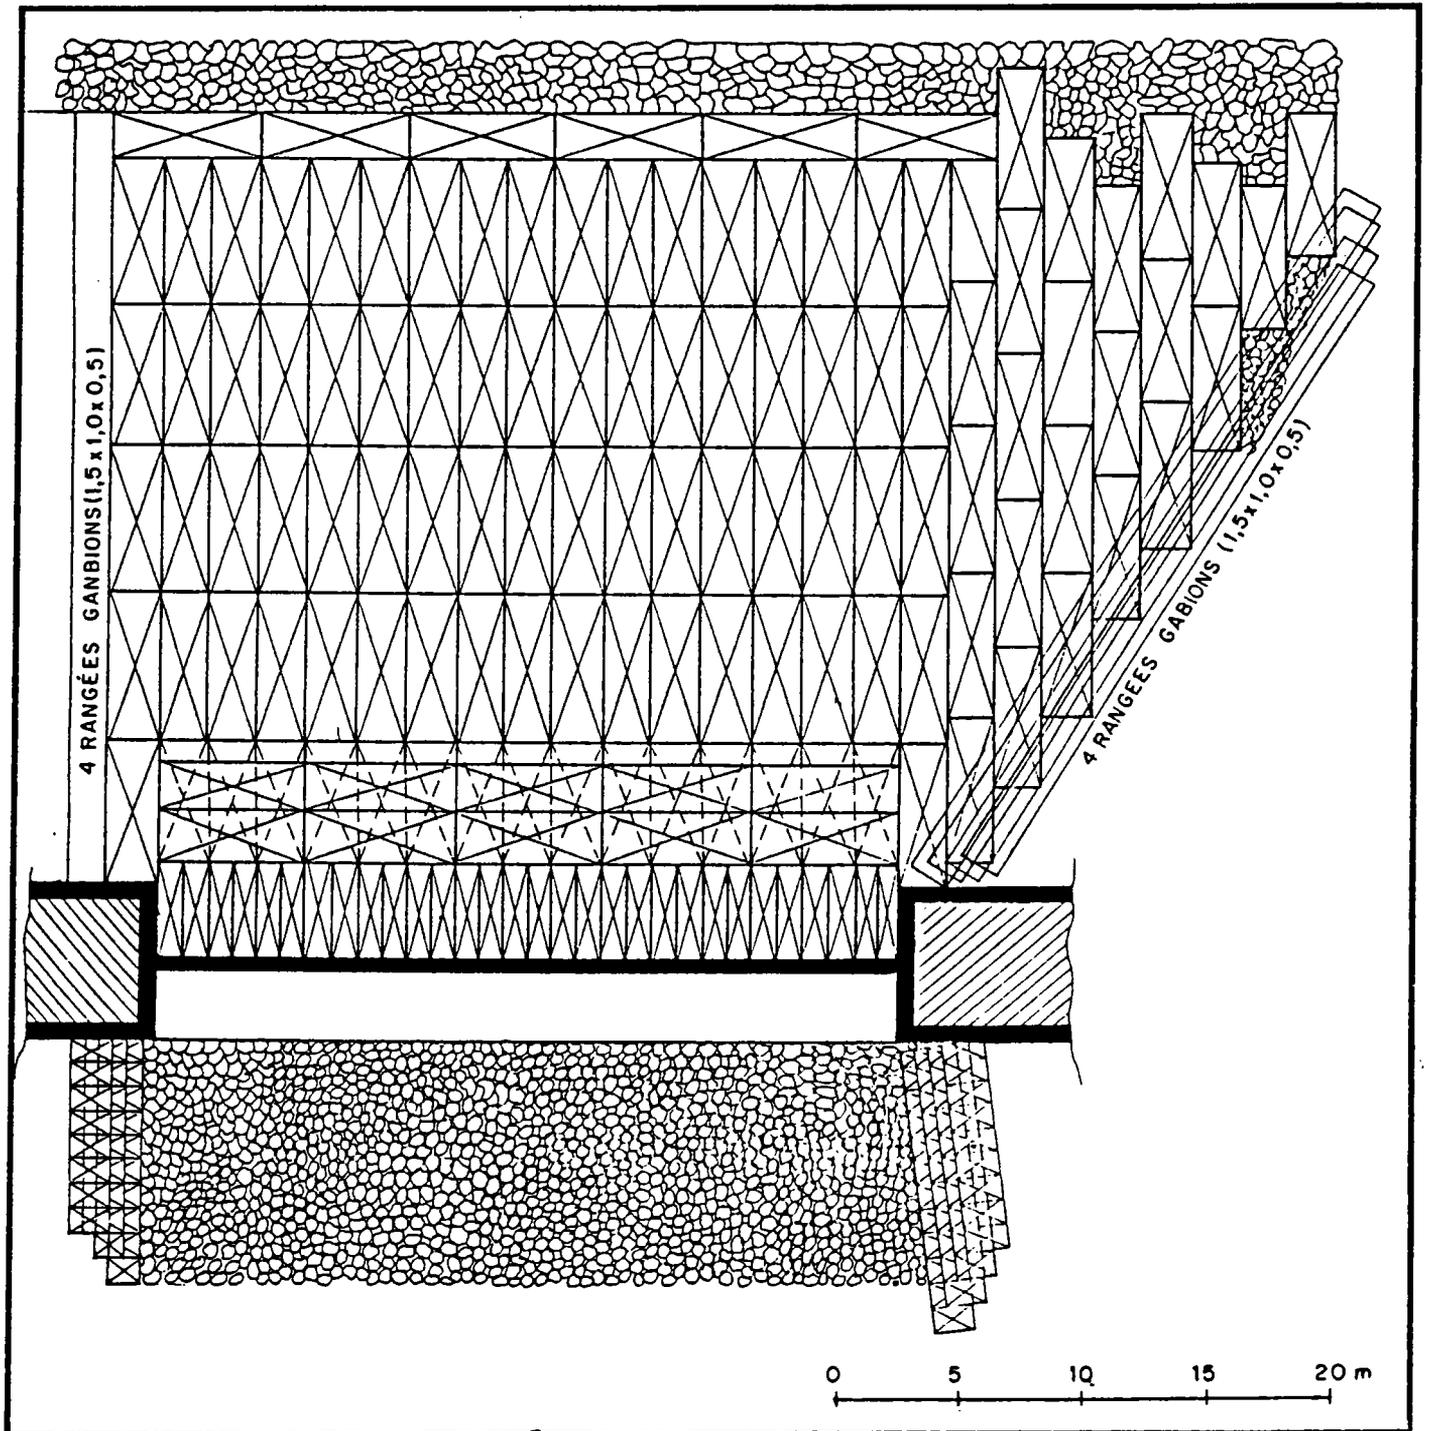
Barrage de Panthior: plan final de l'ouvrage
